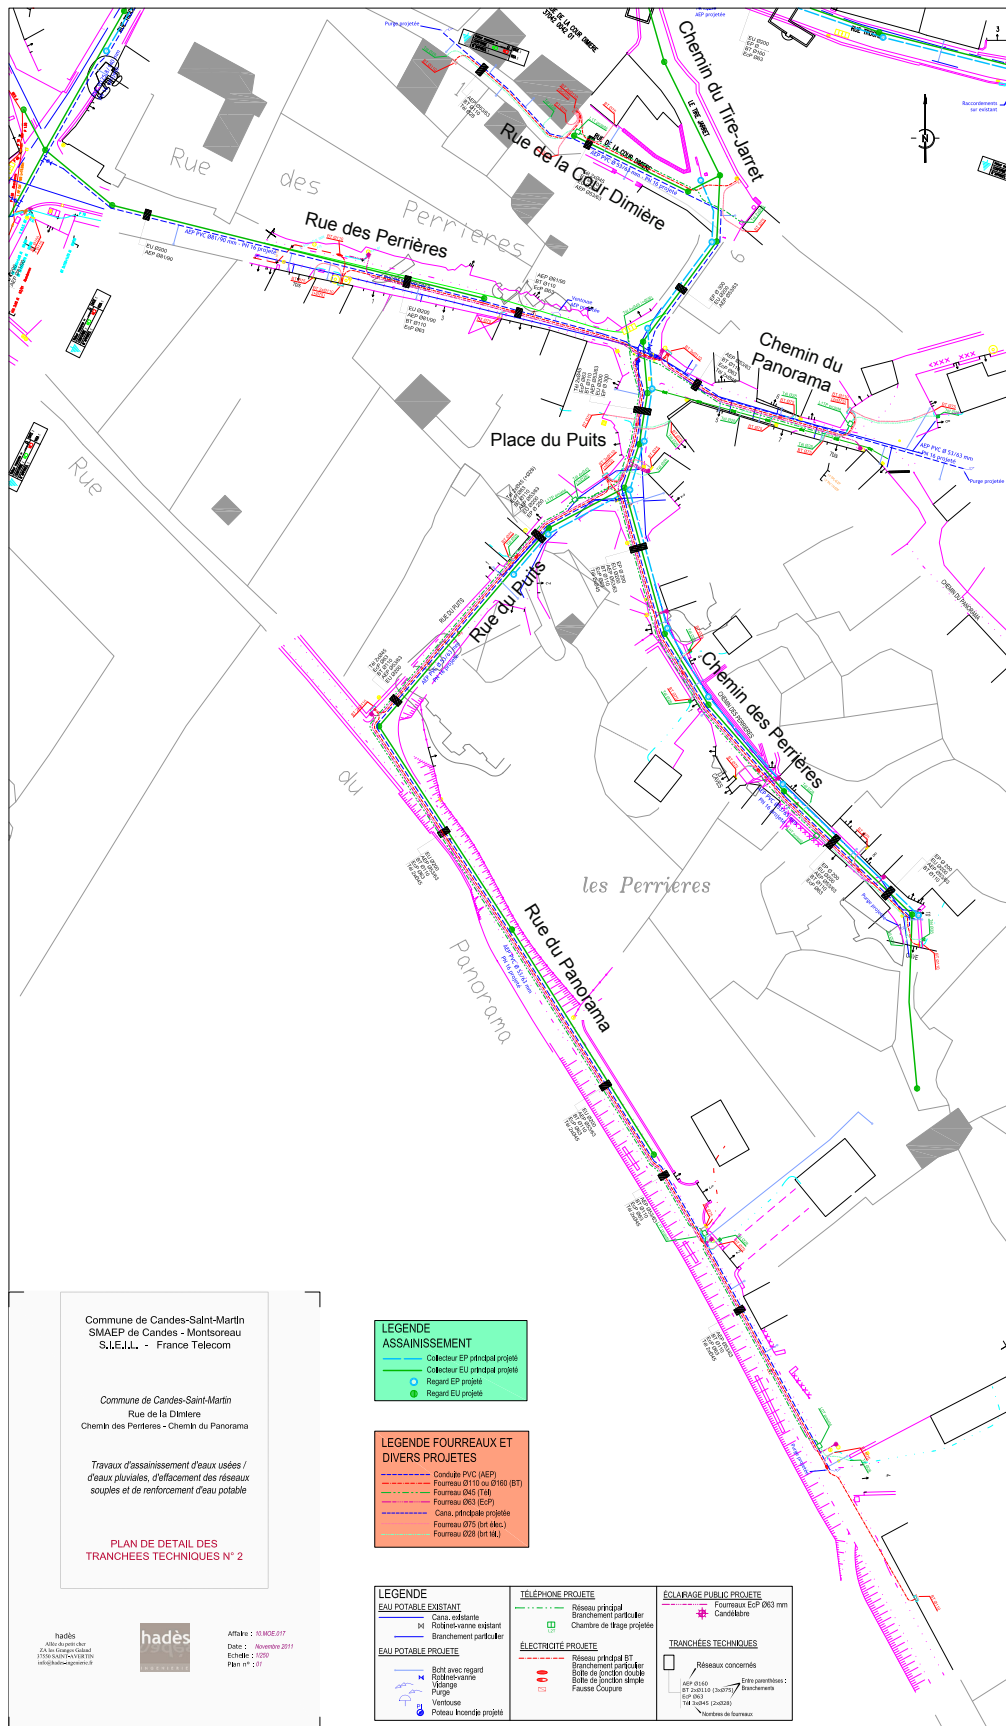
Plan de détail des tranchées techniques (partie est) N° 2 (tranche 2 de travaux d'assainissement) (source : Hadès).
